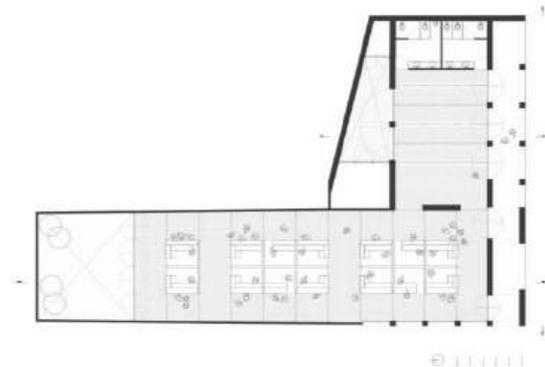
Mercado Tlaxco planta. (Archdaily.2020)
